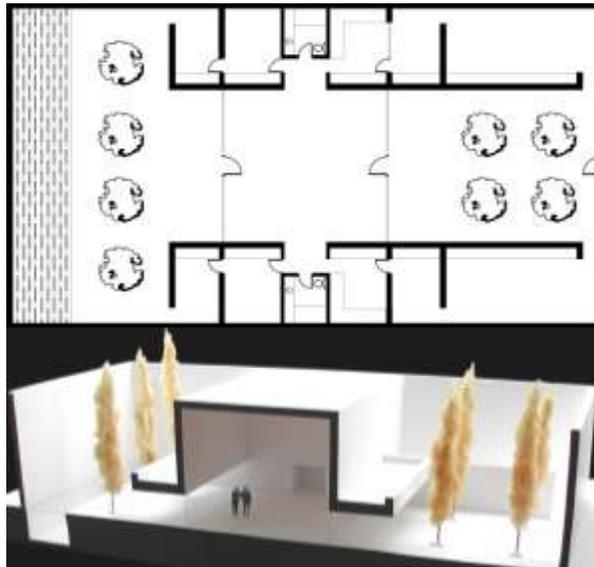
Y FIGURA 49. Planta arquitectónica y sección longitudinal de un modelo de la casa Guerrero.
